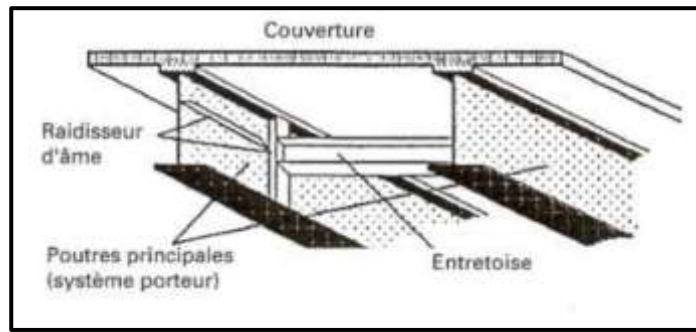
Coupe transversale du tablier d'un pont mixte (acier-béton).
